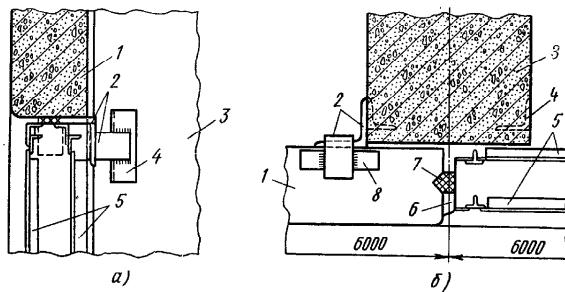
Сопряжение стальных оконных панелей со стеновыми панелями и колоннами:
